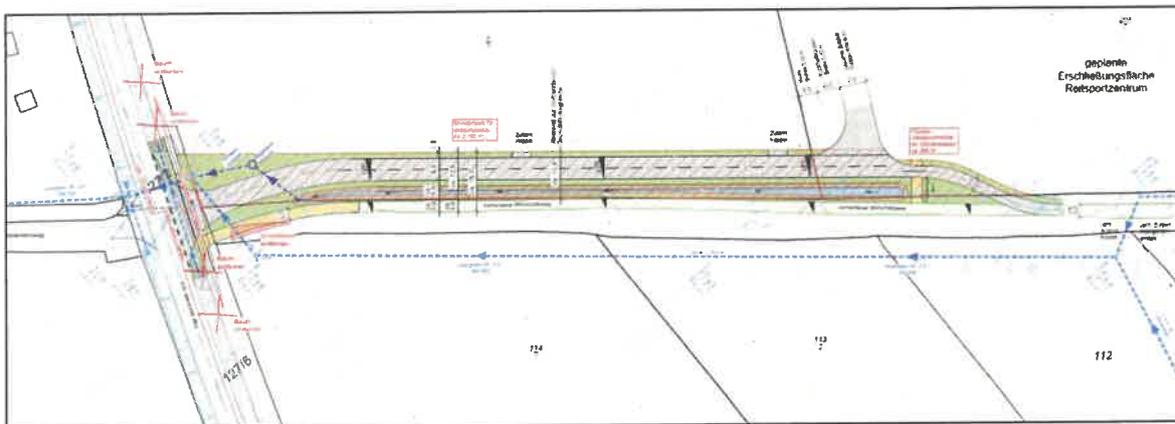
straßenbauliches Erschließungskonzept, Lageplan
